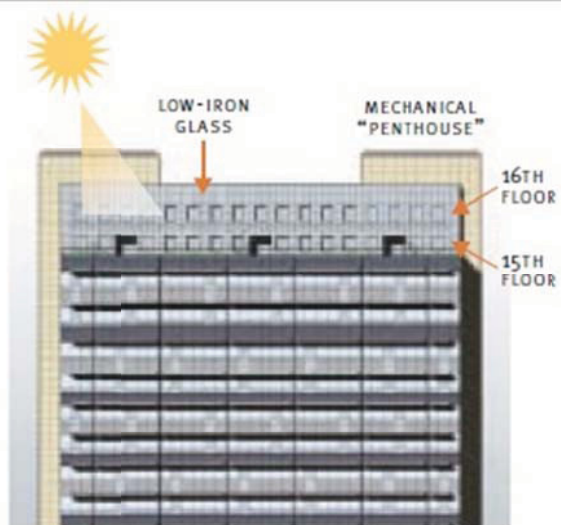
Muro di Trombe nel prospetto sud.
